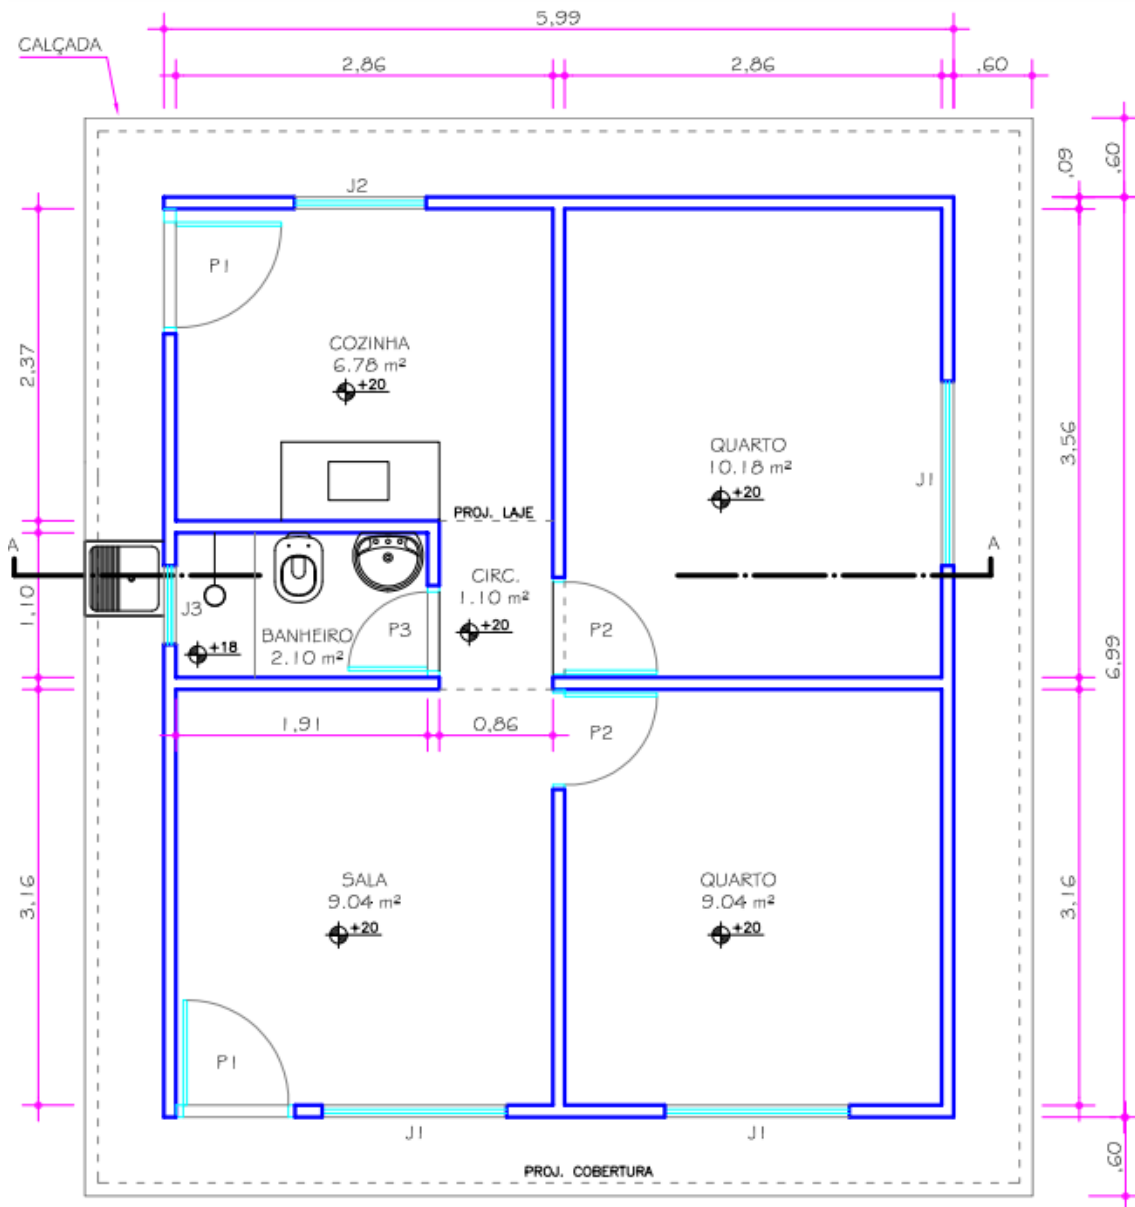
Planta baixa casa popular dos Cadernos CAIXA
